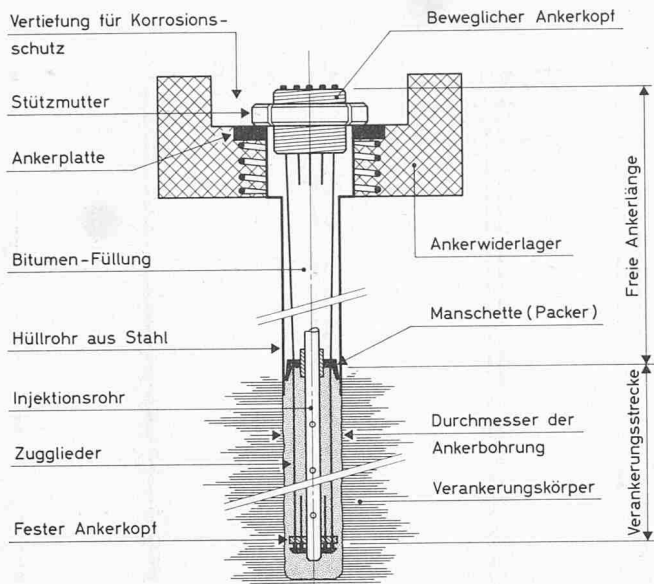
Korrosionsgeschützter Lockergesteinsanker Typ BBRV
